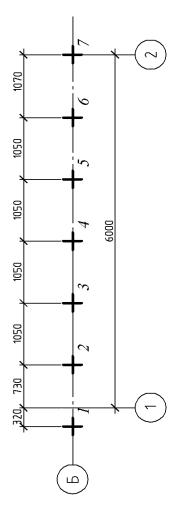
Пример оформления плана свай ленточного свайного фундамента
